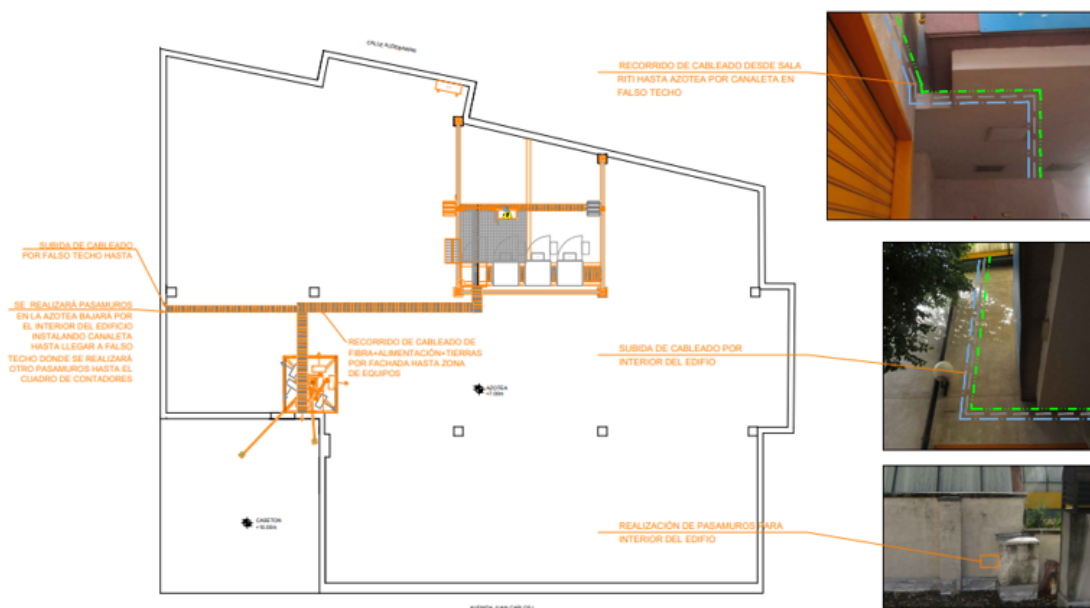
Ejemplo de plano del CAP visto en planta. Elaboración propia.
